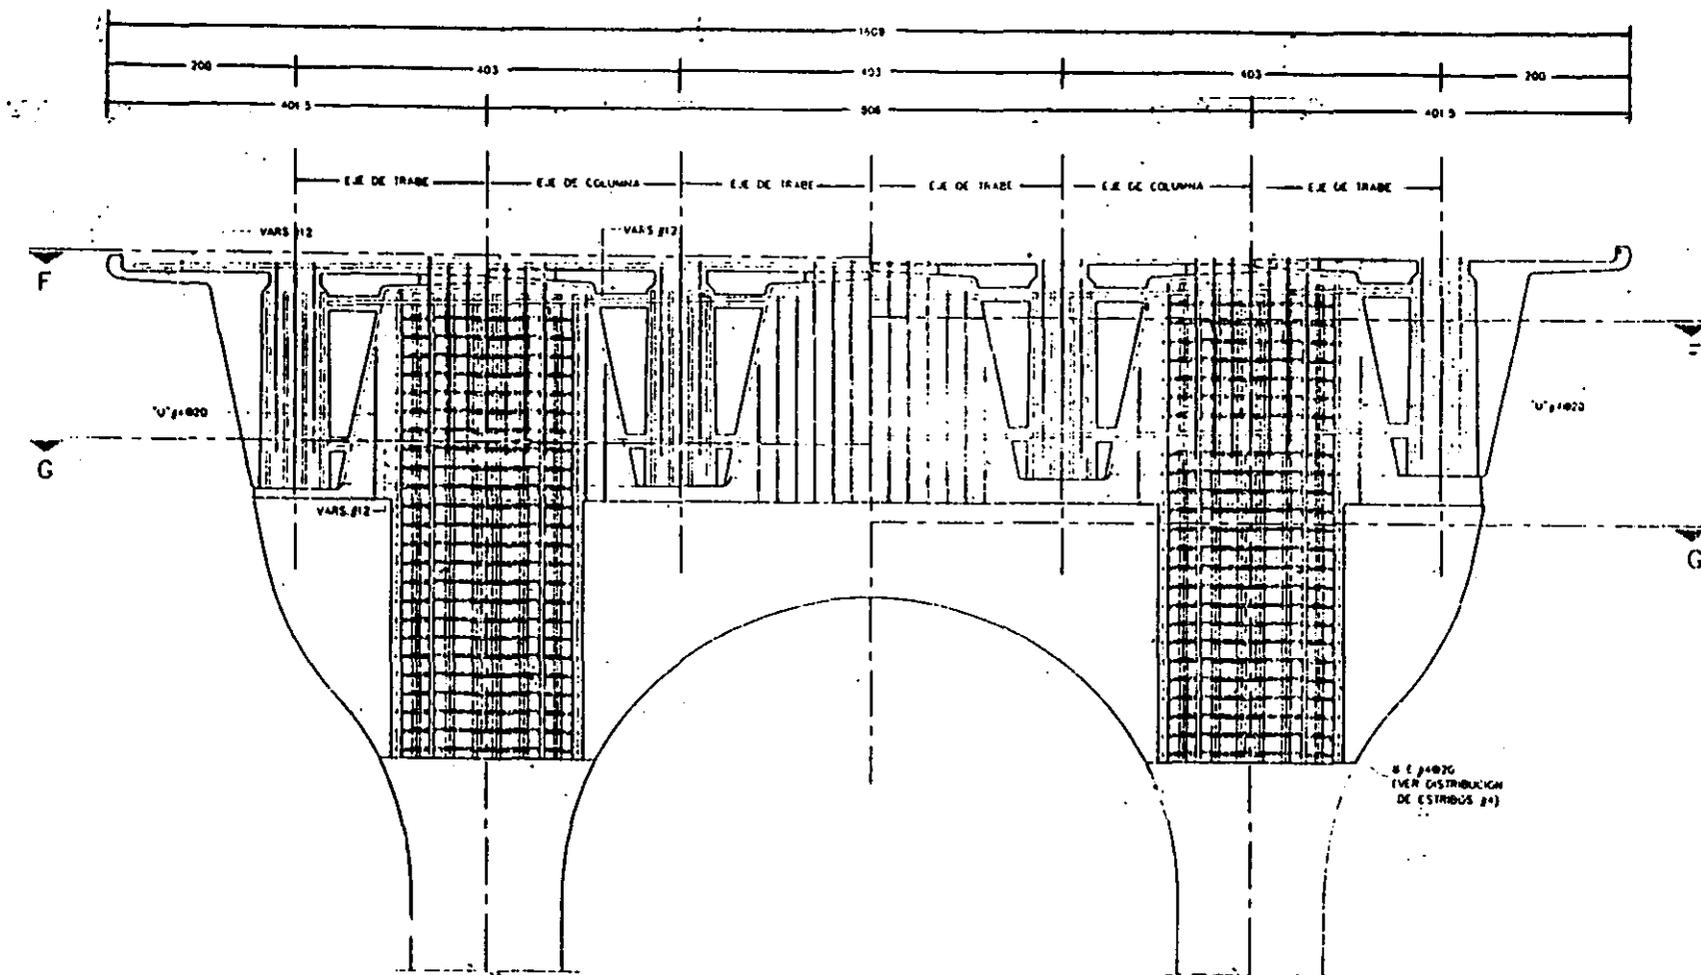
A. Ensamble entre las Columnas y el Cabezal
